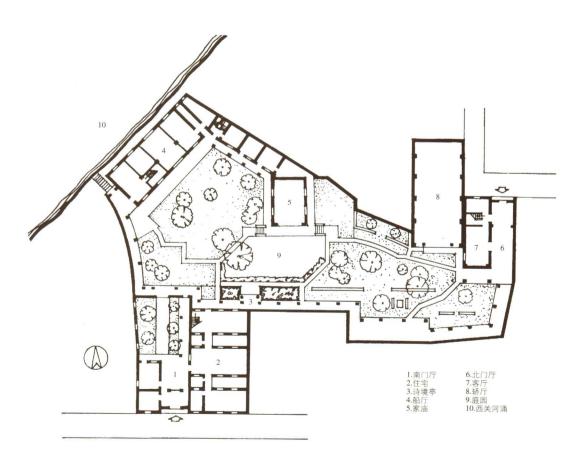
小画舫斋庭园平面图 Plan view of the garden of Little Painted Boat Studio
